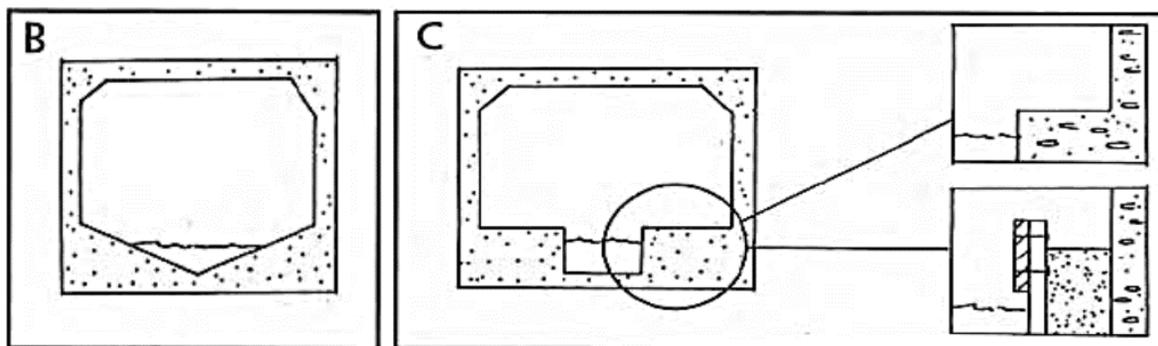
Tipos de obras de drenaje adaptadas como pasos de fauna silvestre.
